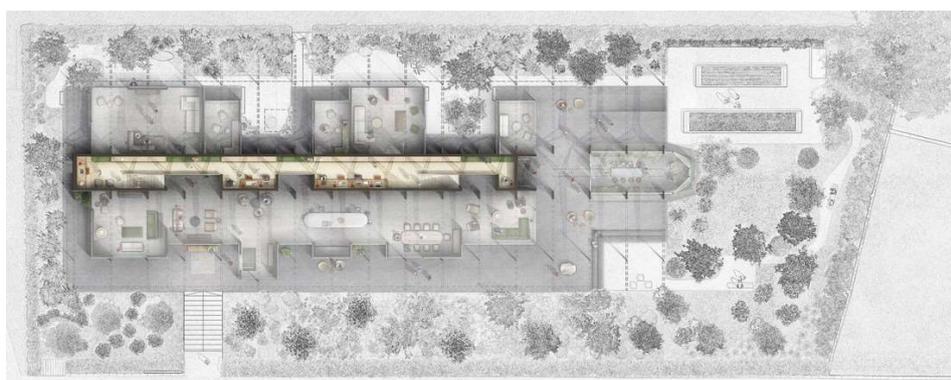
Centro Maggie em Manchester – Planta Baixa.
